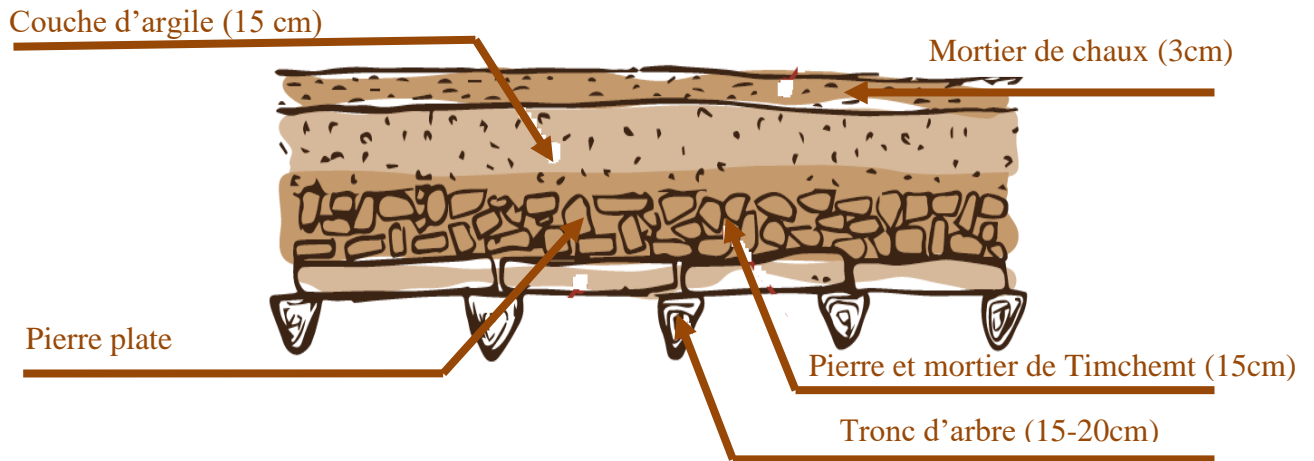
Coupe sur un toit en troncs d'arbre et de pierre plate (OPVM, 2013)
